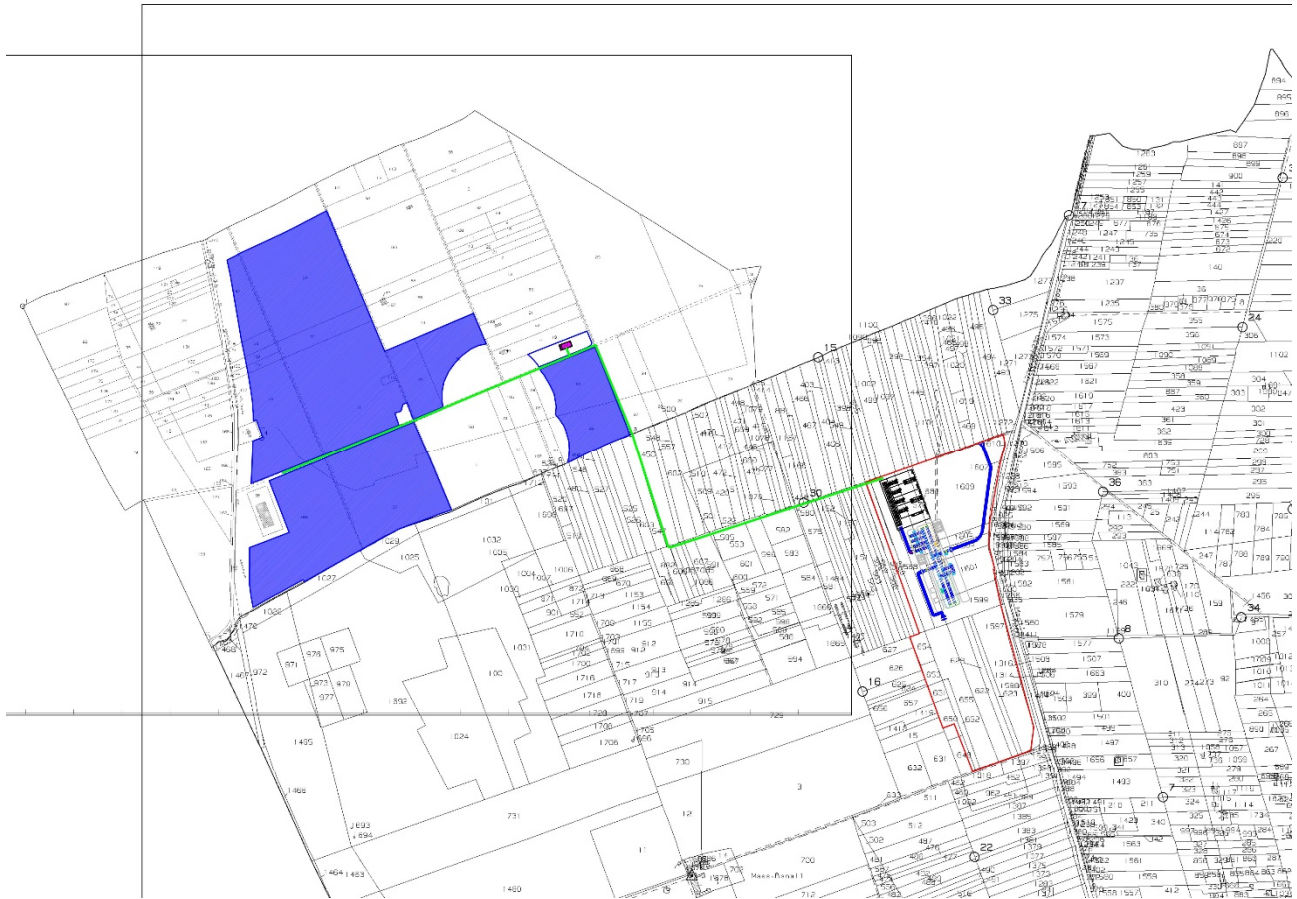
ESTRATTO MAPPE CATASTO TERRENI CON CAVIDOTTO DI CONNESSIONE
